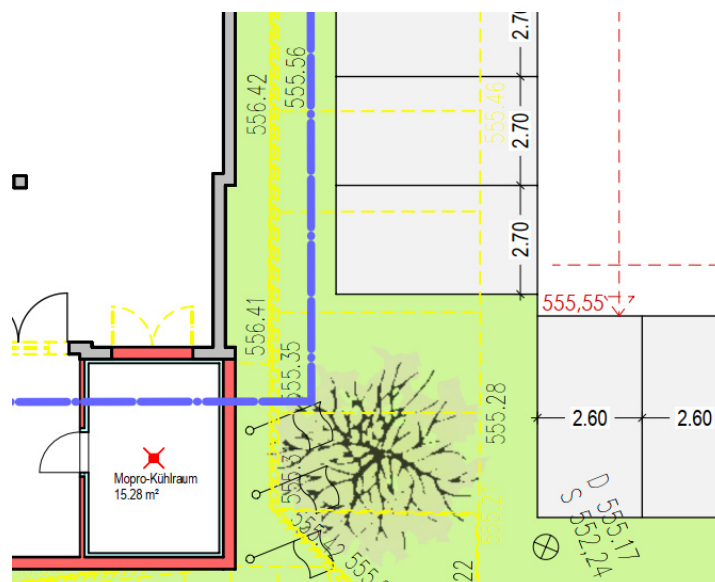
Ausschnitt aus dem Lageplan, zukünftiger Standort Presscontainer
